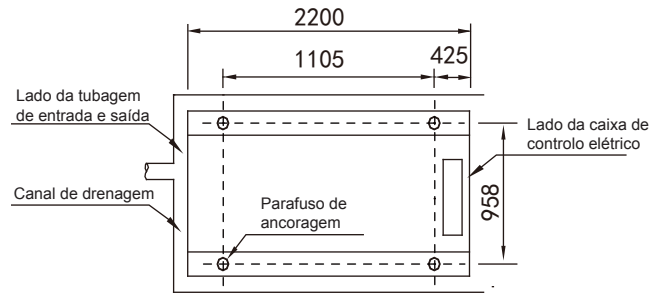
Vista superior do diagrama esquemático das dimensões de instalação do KEM-60 DRS4.1
